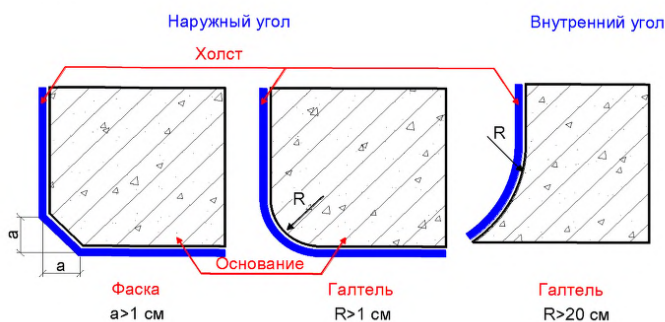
Подготовка углов конструкции перед приклеиванием холстов
